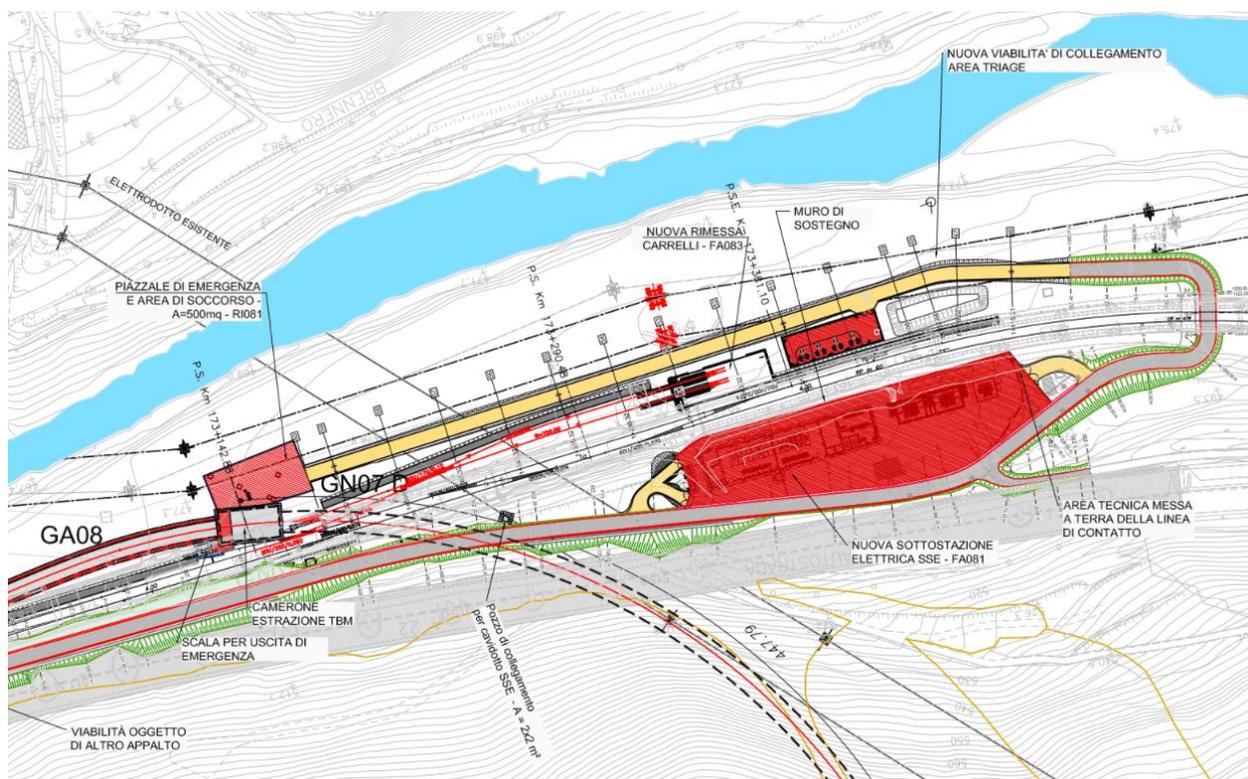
Planimetria di PD in zona Ponte Gardena - configurazione dei tralicci Terna modificata
